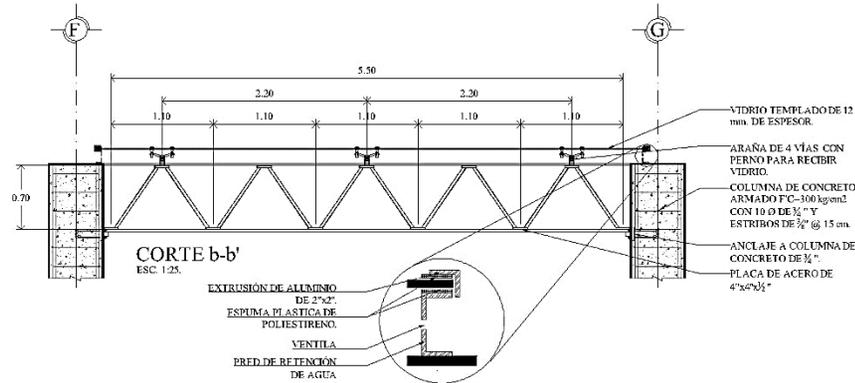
Detalle de tragaluz núcleo de escalera.
